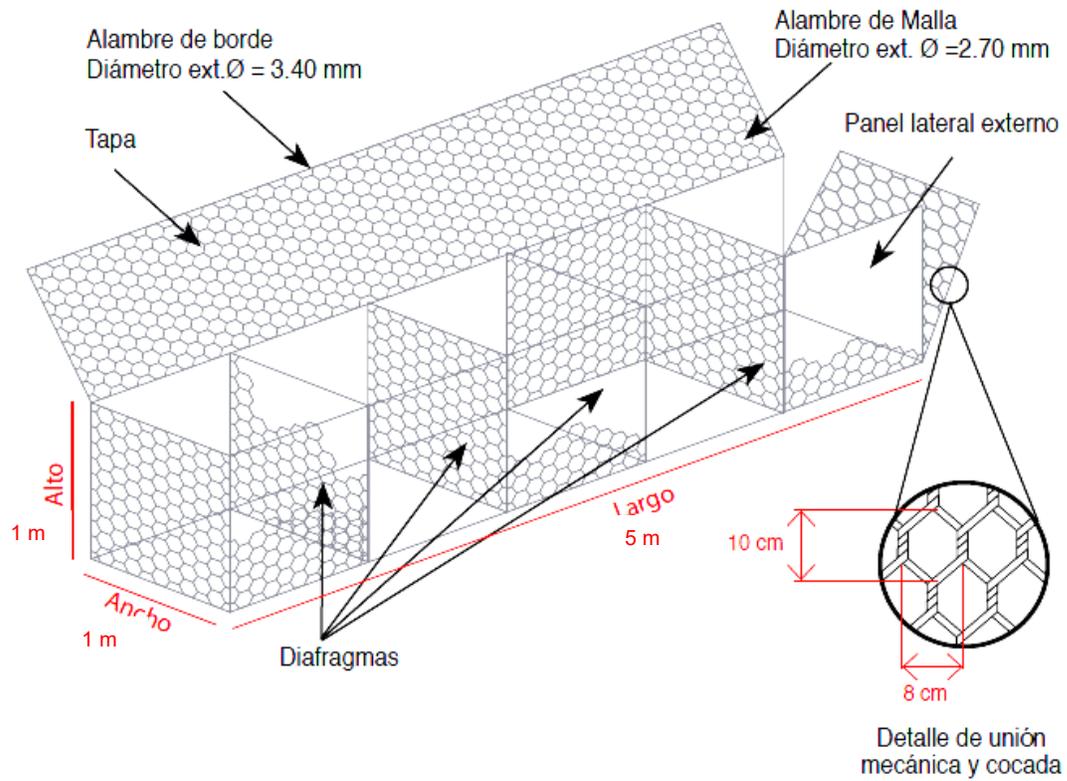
Detalle de las estructuras gavión a utilizarse en los muros y el aspecto que tendrían dichos muros.
